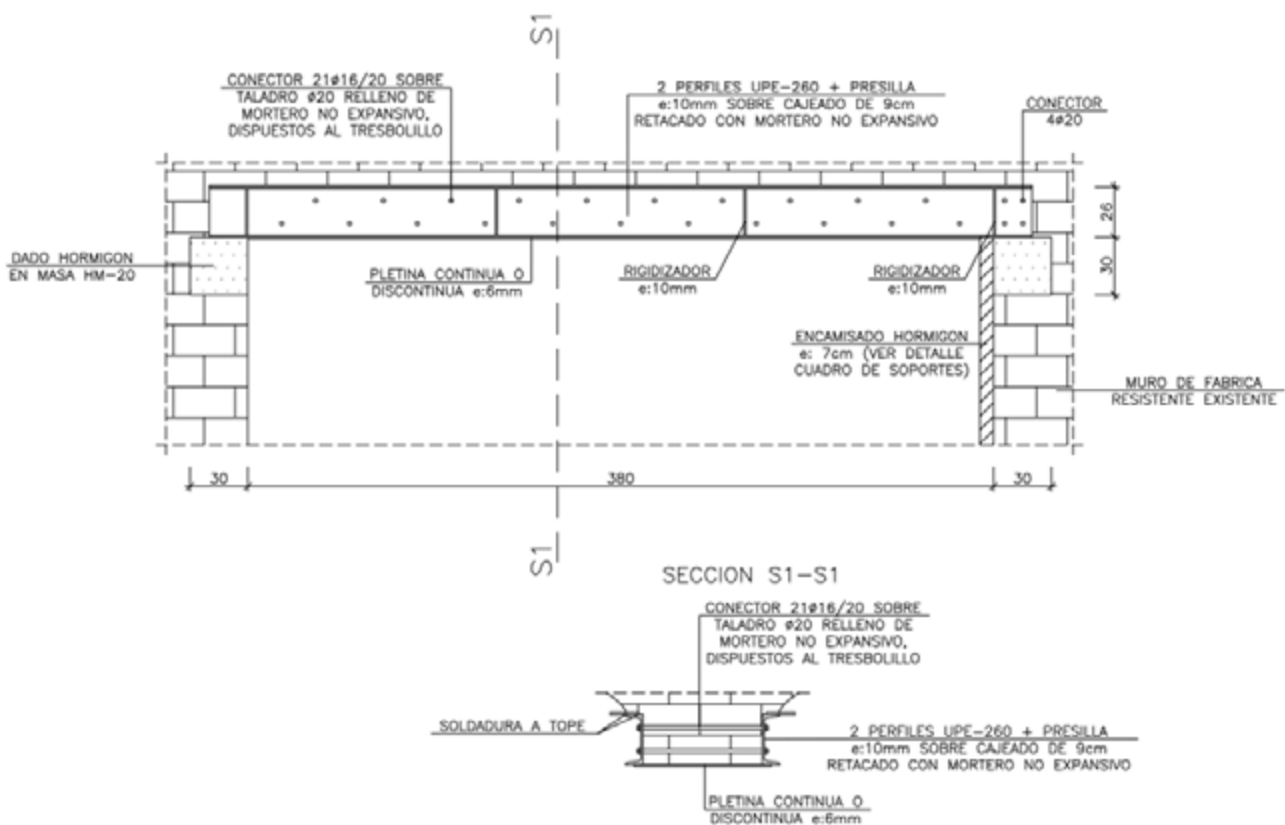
Dintel 2. Apertura de hueco en la planta sótano.
